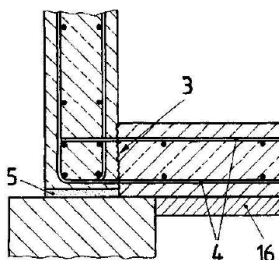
Behälterwand aus Stahlbetonfertigteilen, Stahlbetonsohle nachträglich betoniert
